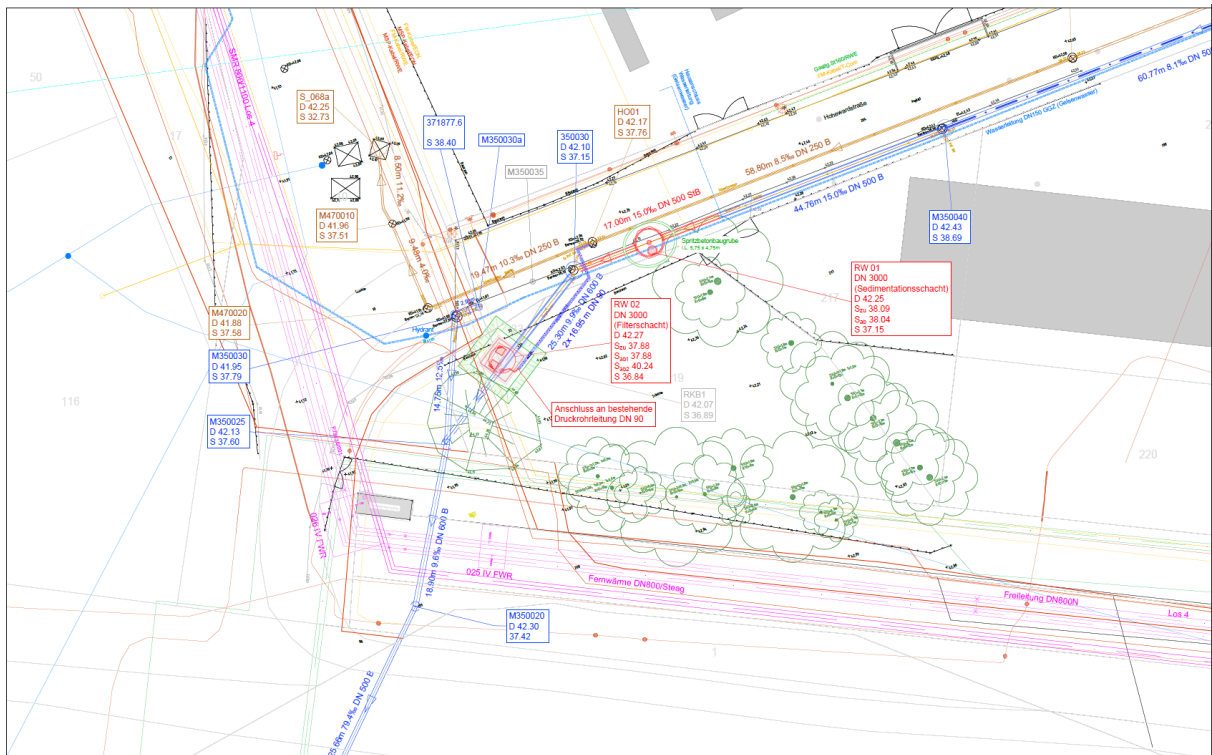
Lageplan als Auszug (Vorabzug Genehmigungsplanung) zur Regenwasserbehandlungsanlage.
